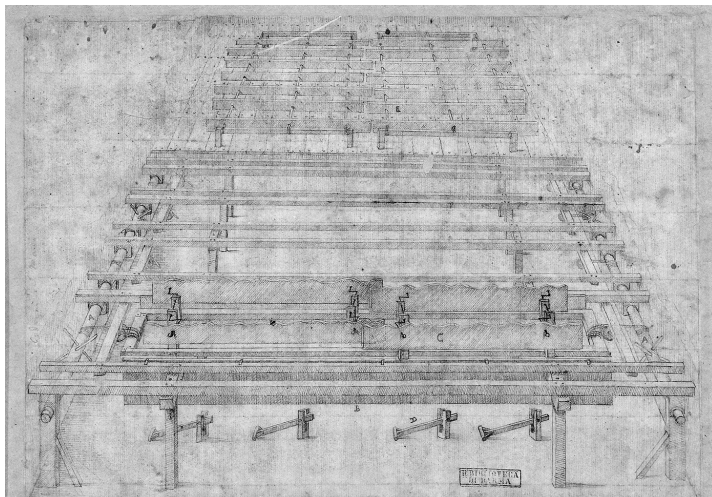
Giovan Battista Lambranzi, Pavimento del palcoscenico del Teatro Vendramin a Venezia, 1675. Disegno. Parma Biblioteca Palatina. Mss Parmense 3708.
